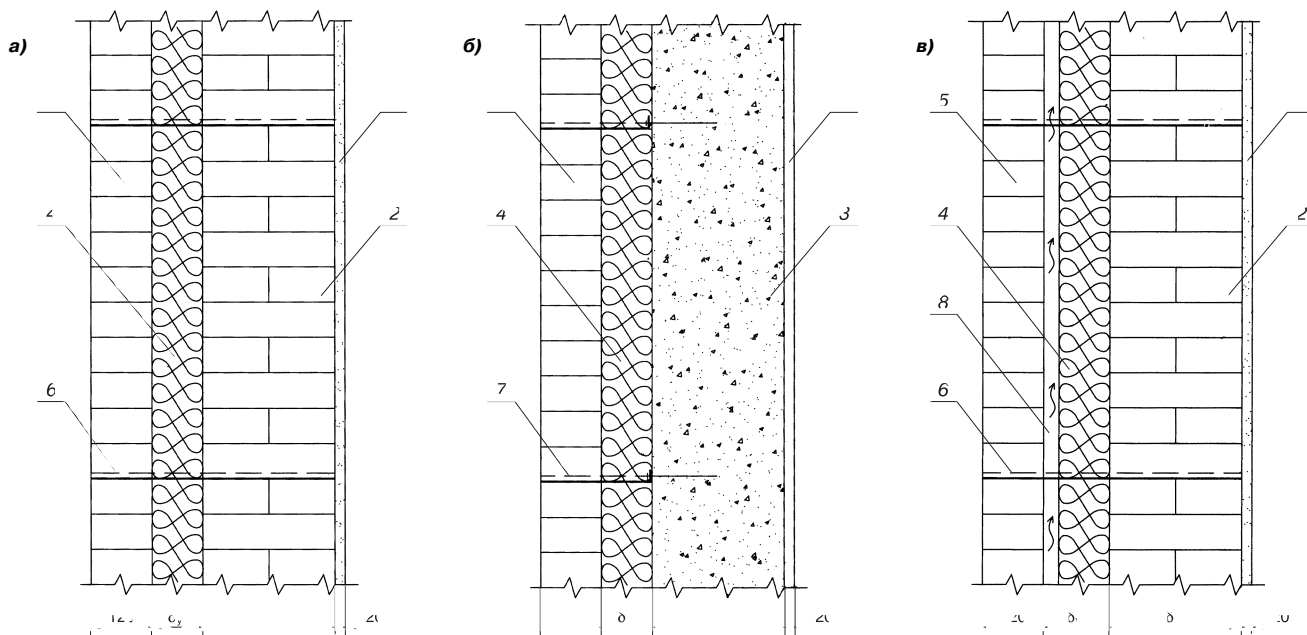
Схемы утепления стен плитами «URSA». 1 – внутренняя штукатурка; 2 – несущая кирпичная стена; 3 – несущая панельная стена; 4 – плиты «URSA»; 5 – облицовка из лицевого кирпича; 6 – гибкие связи; 7 – анкер и связи; 8 – вентилируемый зазор.
